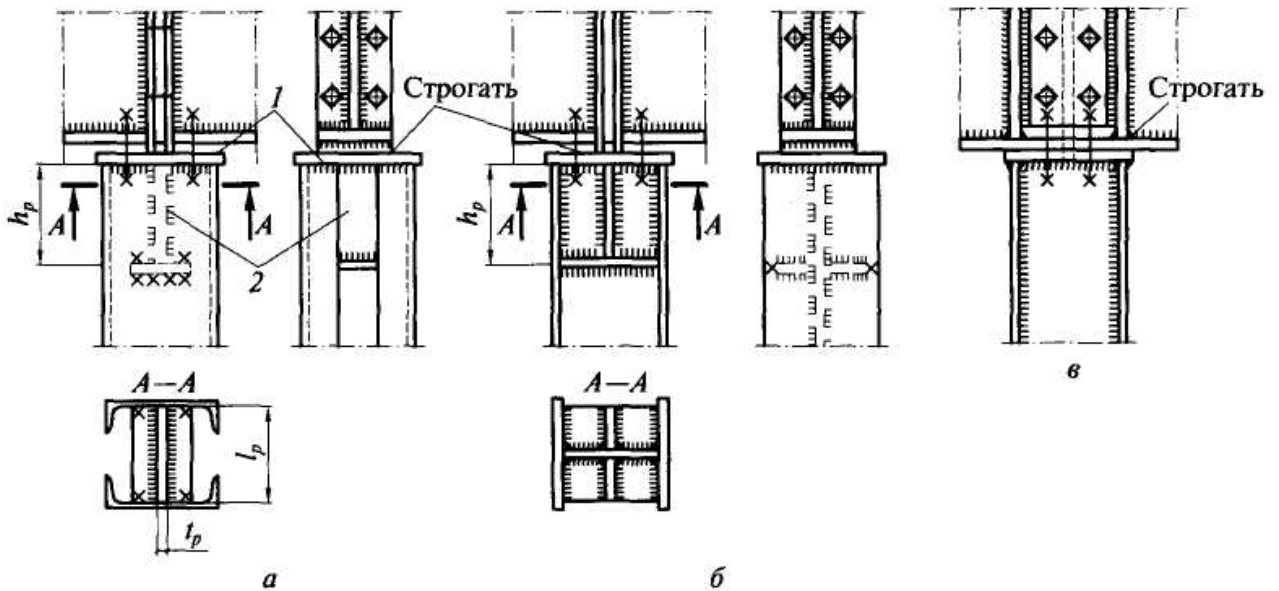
Оголовки колонн при опирании балок сверху:
